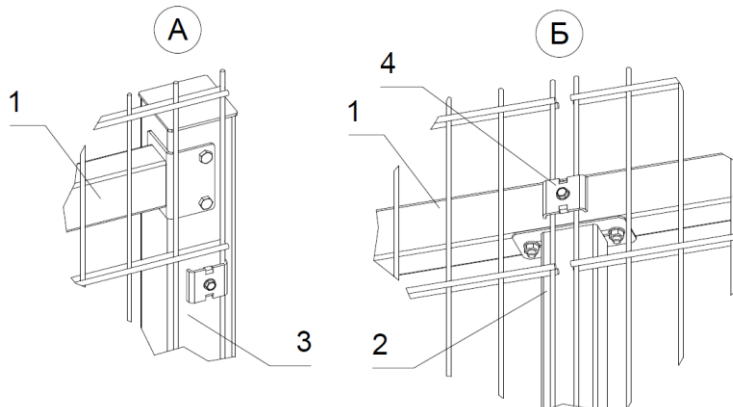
Узлы крепления перемычек (1 – горизонтальная перемычка, 2 – вертикальная перемычка, 3 – столб ворот, 4 – прижимная планка ПП.40.30 с саморезом).
